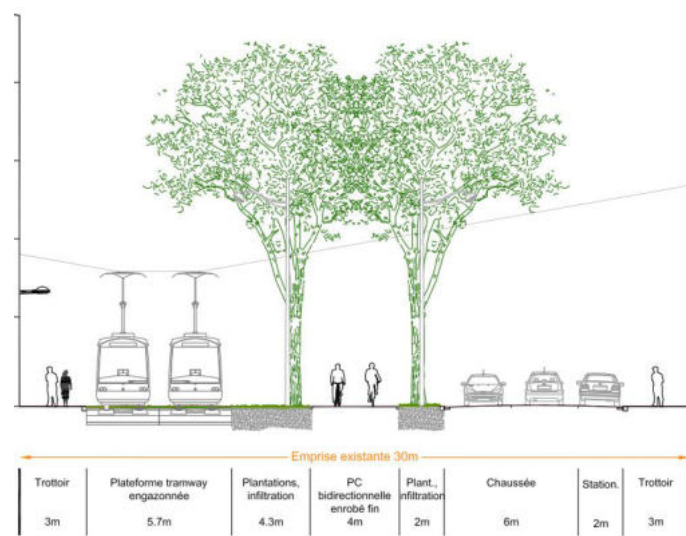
COUPE ET PLAN RUE DE WISSEMBOURG
